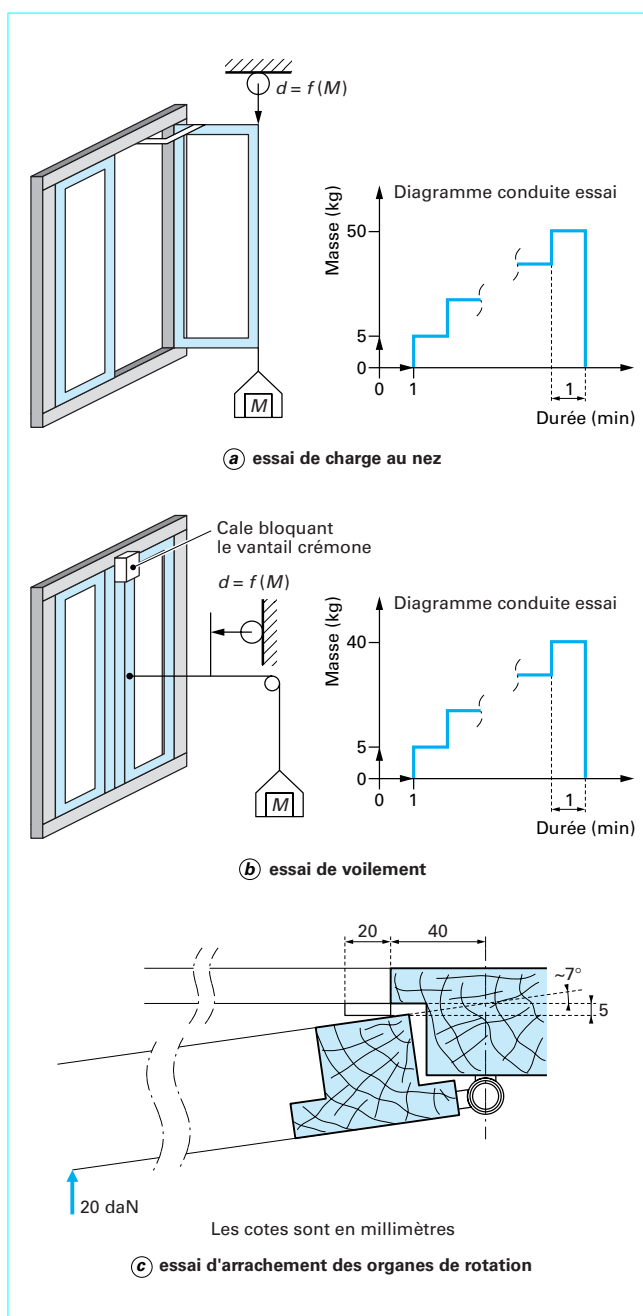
Essais mécaniques pour vantail pivotant autour d'une rive verticale
